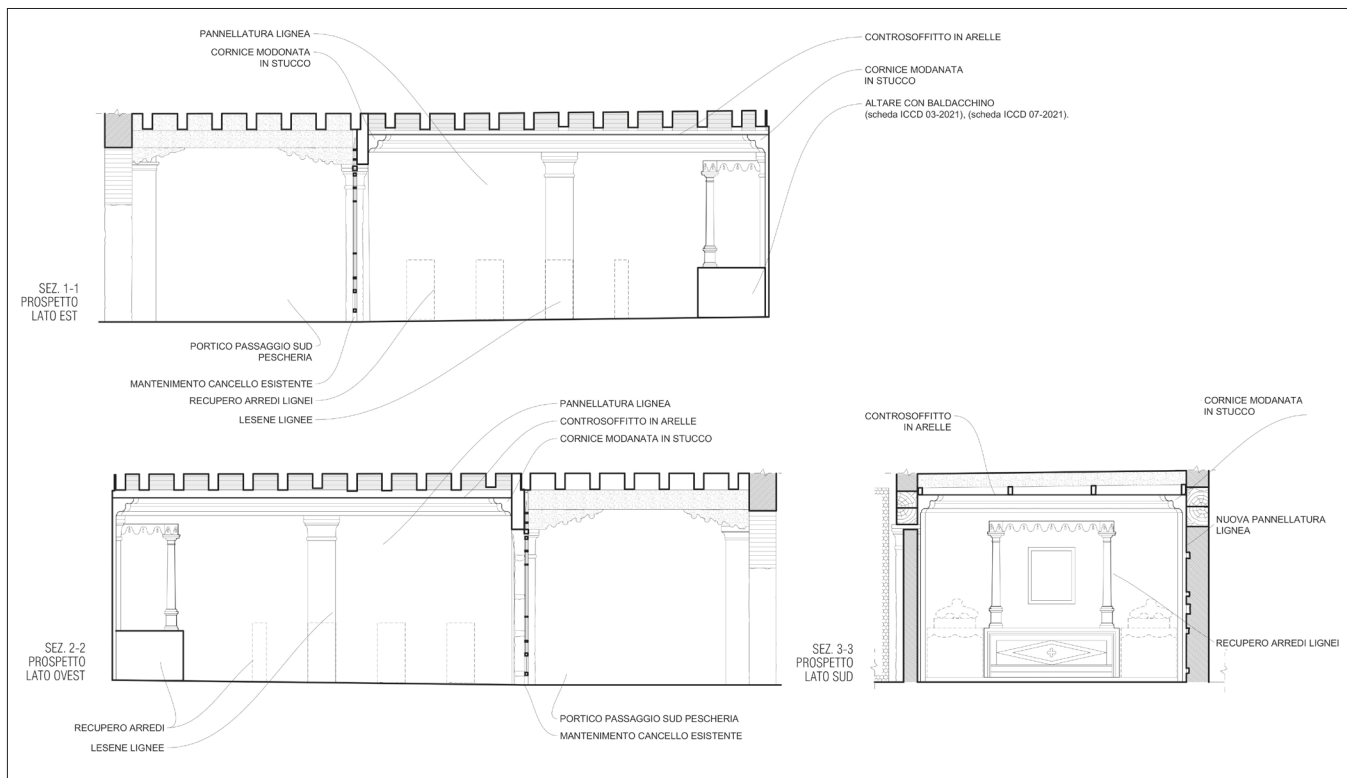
Chiesetta della Madonnina del Granaio. Progetto di restituzione – sezioni (arch. Alberta Baldin)
